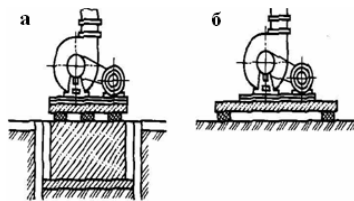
Установка агрегатів на віброгасні основи: а - на фундаменті і на ґрунті; б - на перекритті.
